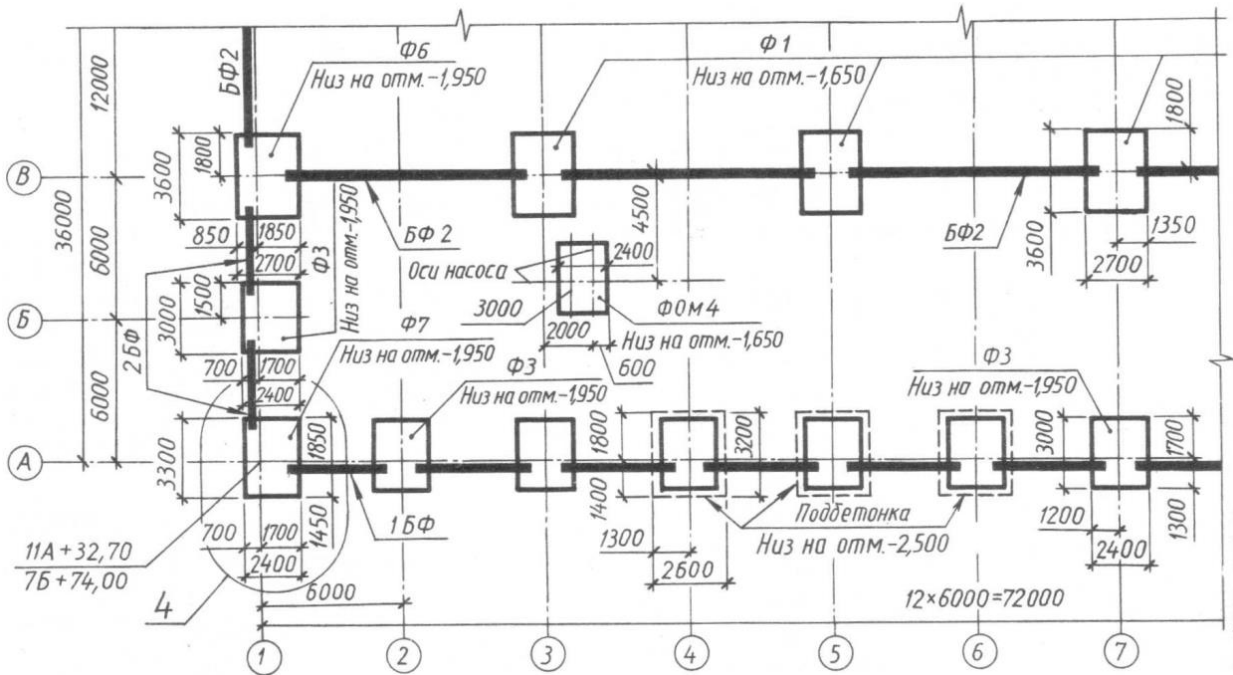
Фрагмент схеми розташування фундаментів і фундаментних балок
